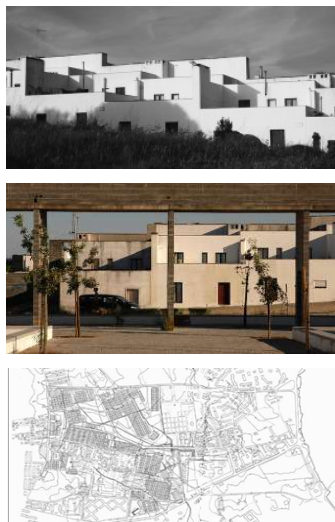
Viviendas Sociales Plano de la intervención, vista exterior de conjunto y detalle de calle entre las viviendas. Quinta da Malcaqueira, 1977, Alvaro Siza.
